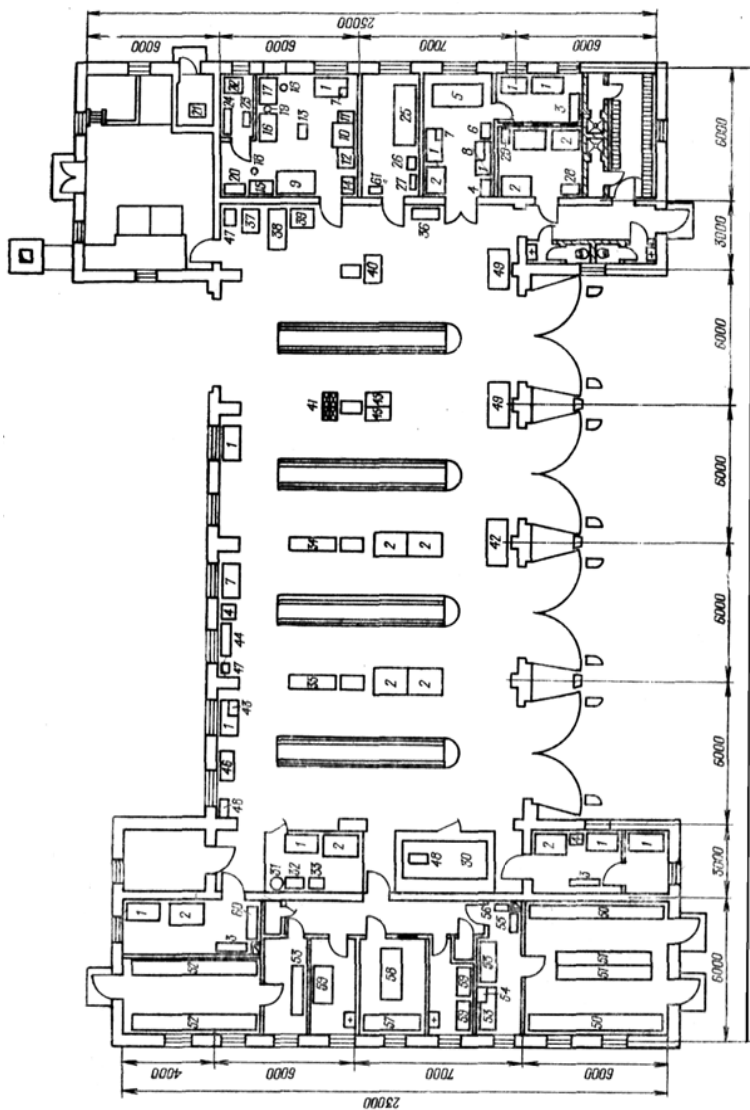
Планировка помещения и расстановка основного оборудования ПТОР машин на четыре поста
